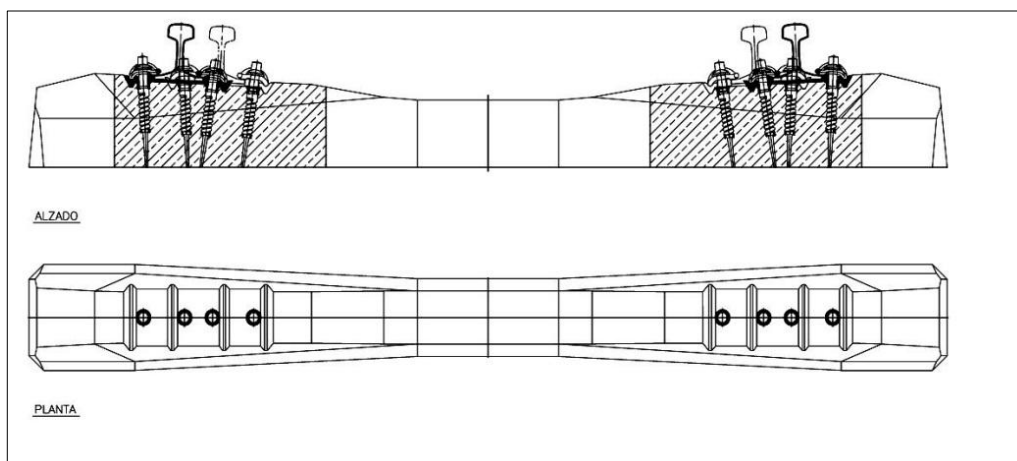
Travessas mono-bloco pré-esforçadas: perfil ^[2]
